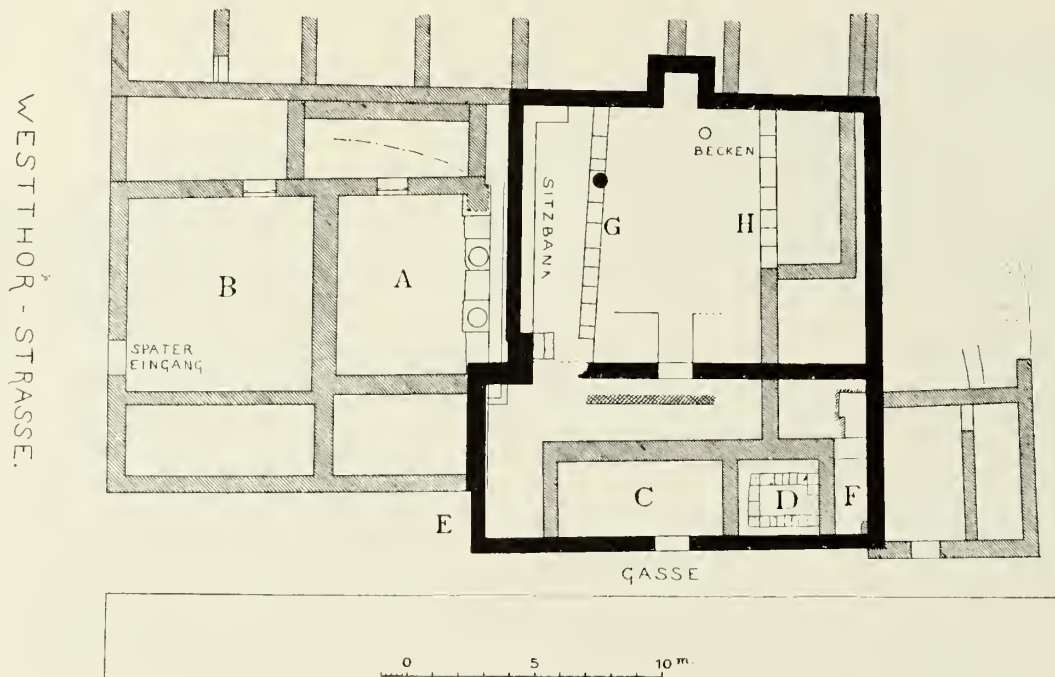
Grundriss der Hauskirche in der Westthorstrasse.
